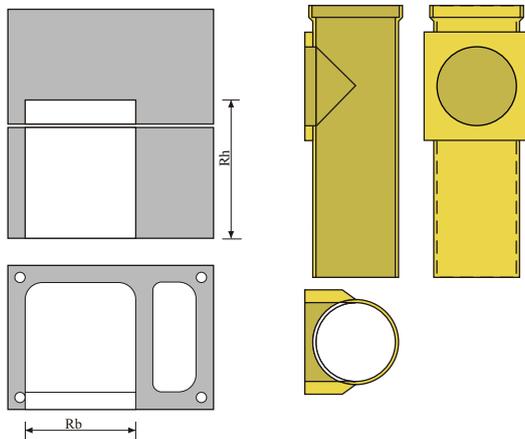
Grundriss und Schnitt Reinigungs- und Kontrollverschluss
